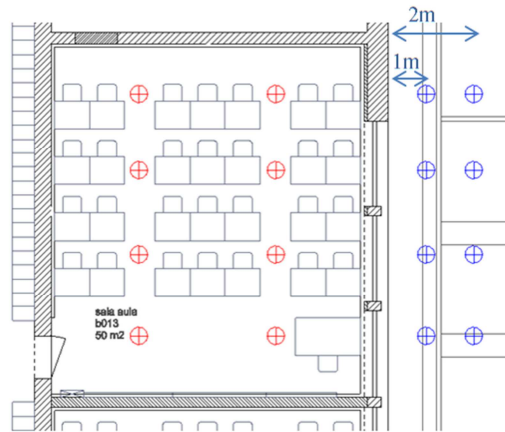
Localização em planta do posicionamento dos equipamentos de medição (ESCR).
